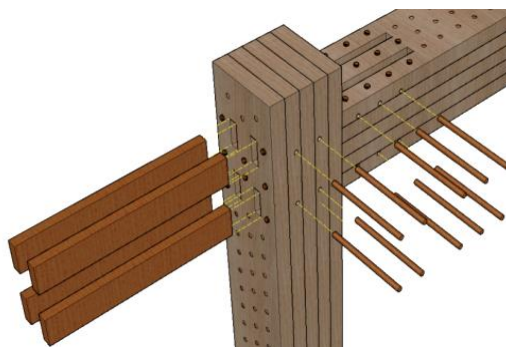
Assemblage Poteau-Poutre sans colle et sans metal [NUI Galway].
